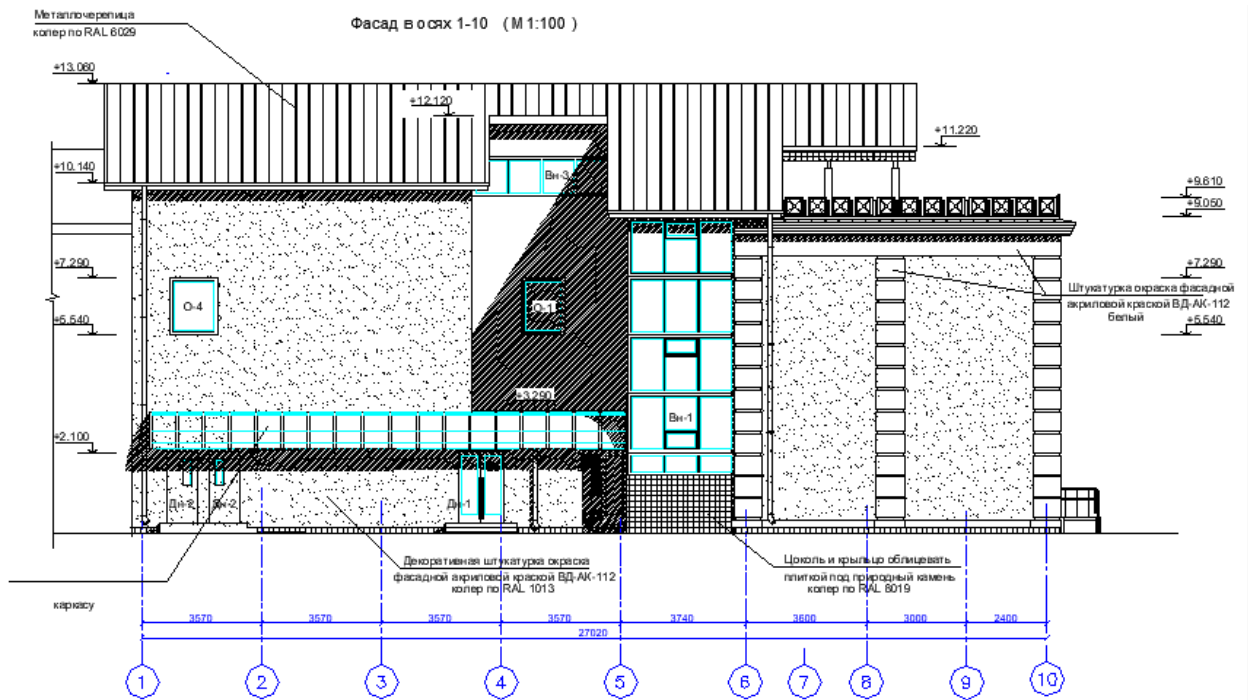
Фасад здания после реконструкции в осях 1-10
